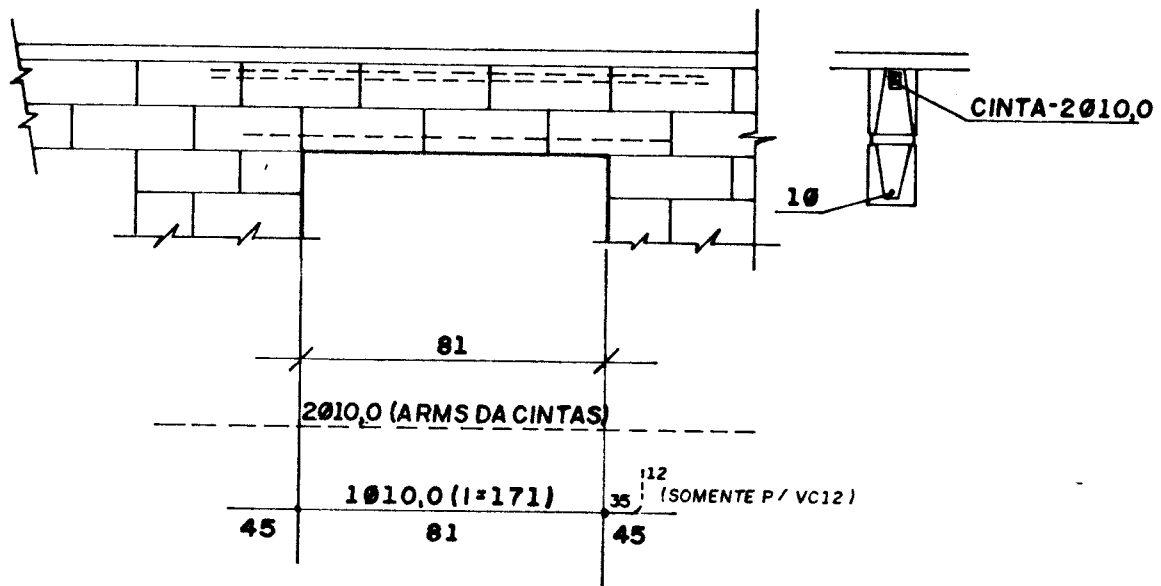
b. ARMAÇÃO DAS VIGAS DO ÚLTIMO PAVIMENTO.
